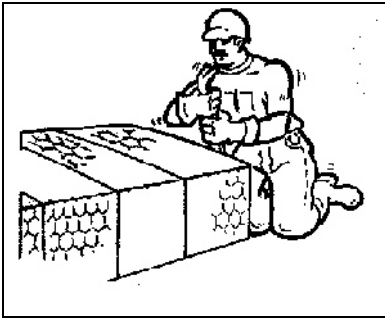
Técnica de armado de los gaviones rectangulares tipo caja
